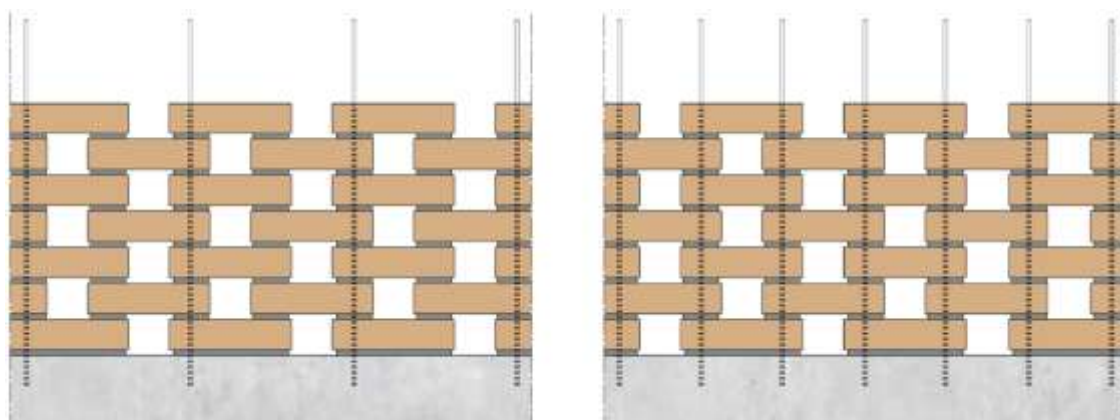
Dispositions des aciers filants (une armature par brique/deux armatures par brique)
